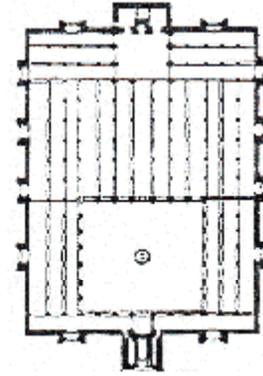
مسقط أفقي لمسجد الزهر بفاس الجديدة
